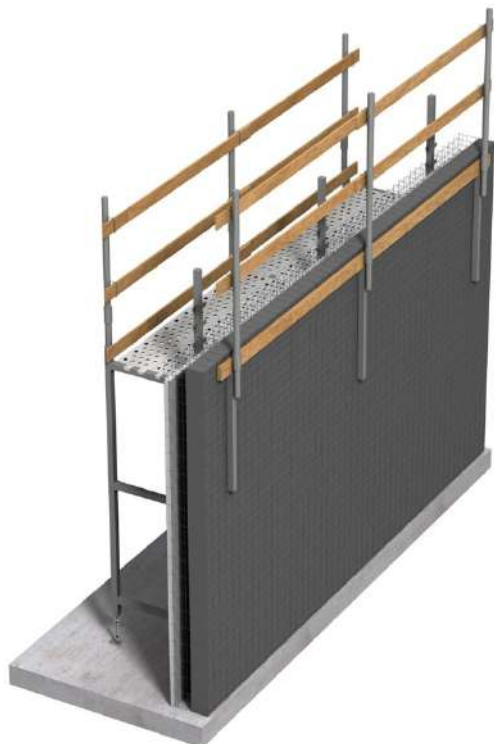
Sistema de alineamiento con barandillas: Soporte de barandilla (3 piezas) y barandillas (6 piezas).
